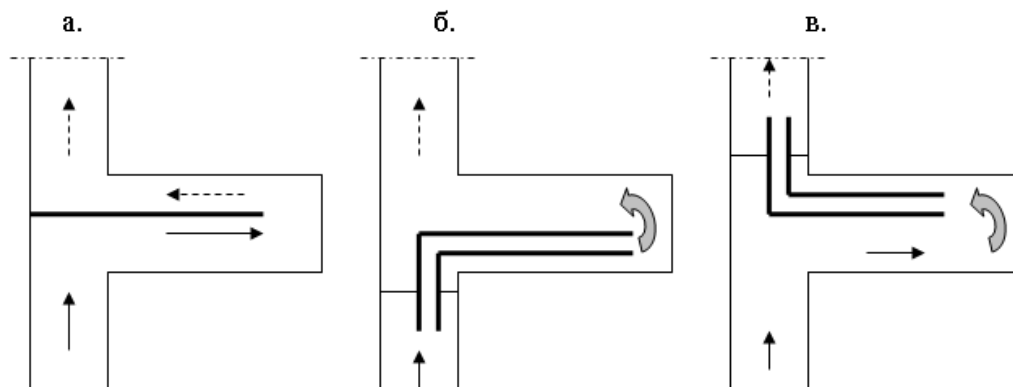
Схемы проветривания тупиковой выработки с помощью перегородки (а) и вентиляционной трубы (б, в)
